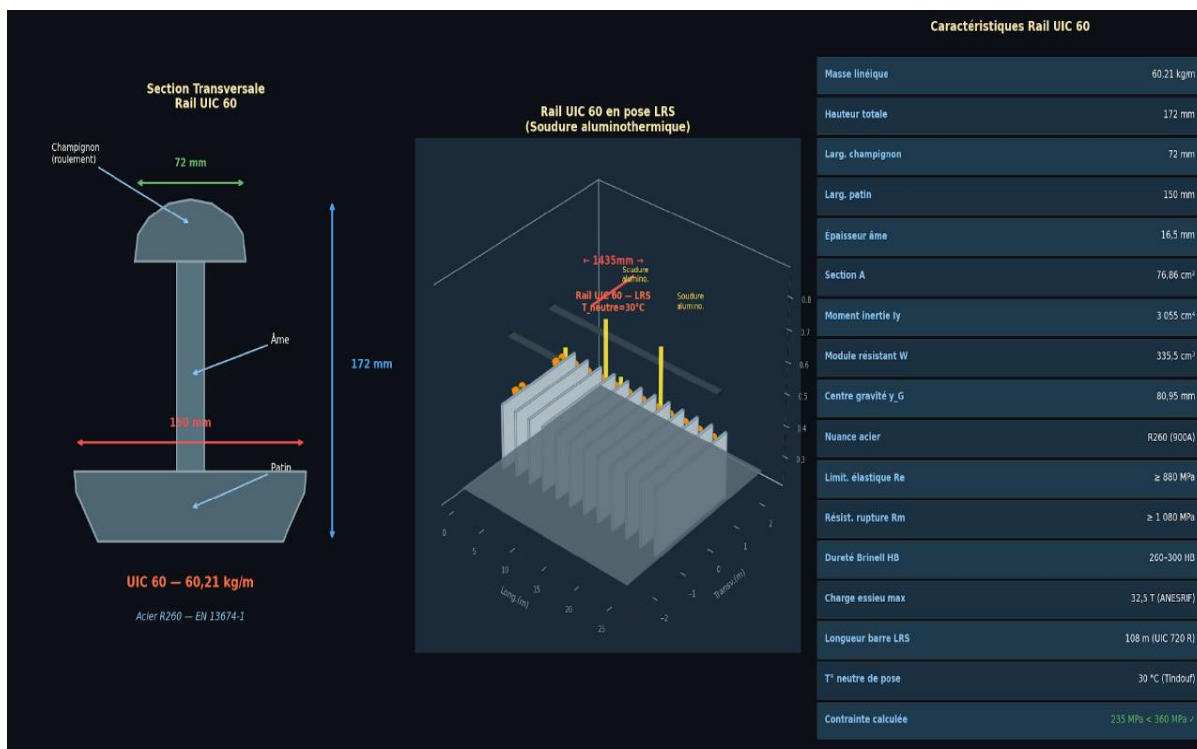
Rail UIC 60 : Section transversale (gauche), pose LRS avec soudures (centre), caractéristiques (droite)
